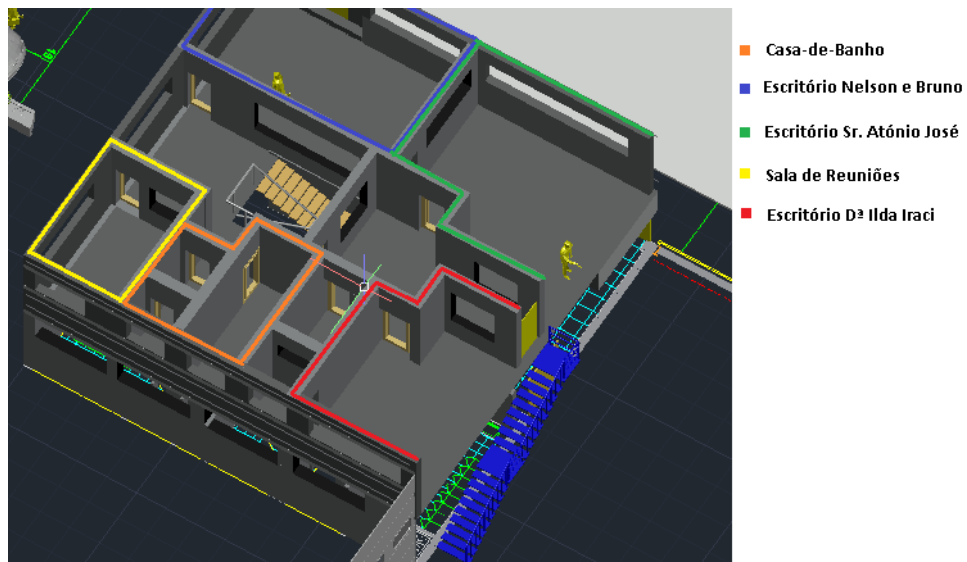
Representação da planta do piso superior em AutoCAD[3]
